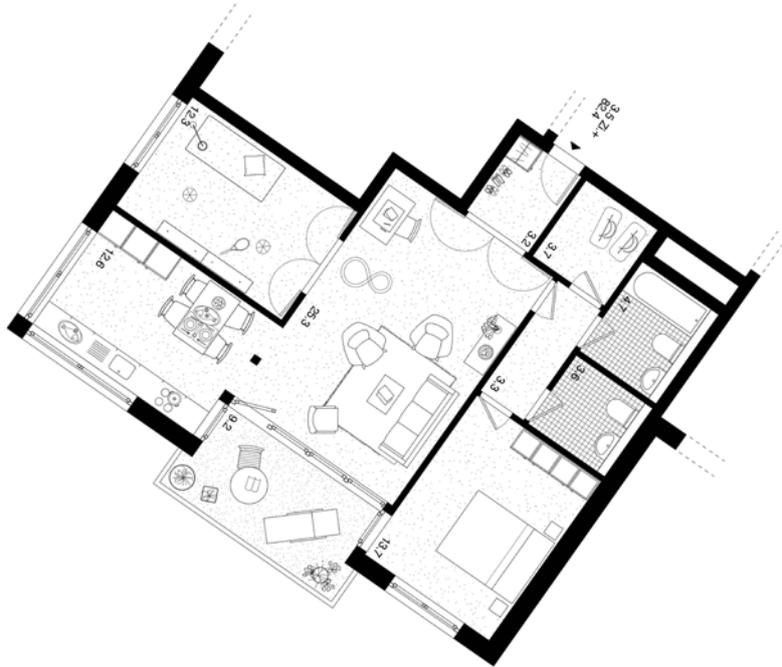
Wohnungsgrundriss 3.5 Zimmer - Whg.
